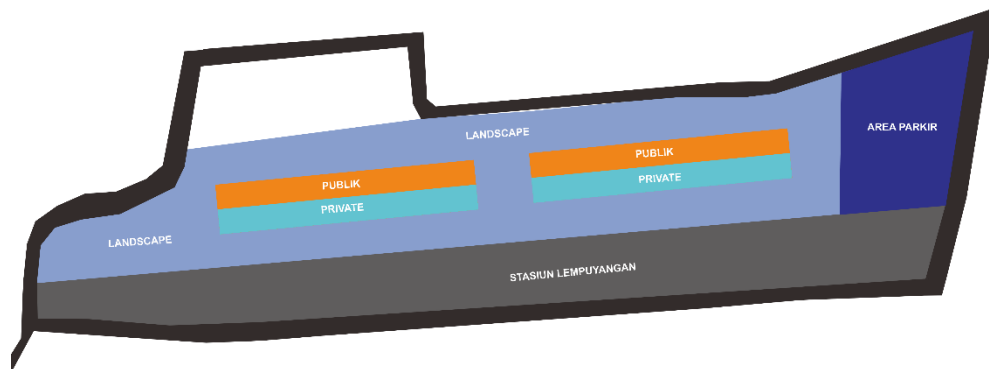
Sketsa Bentuk Massa Bangunan Mixed Use
